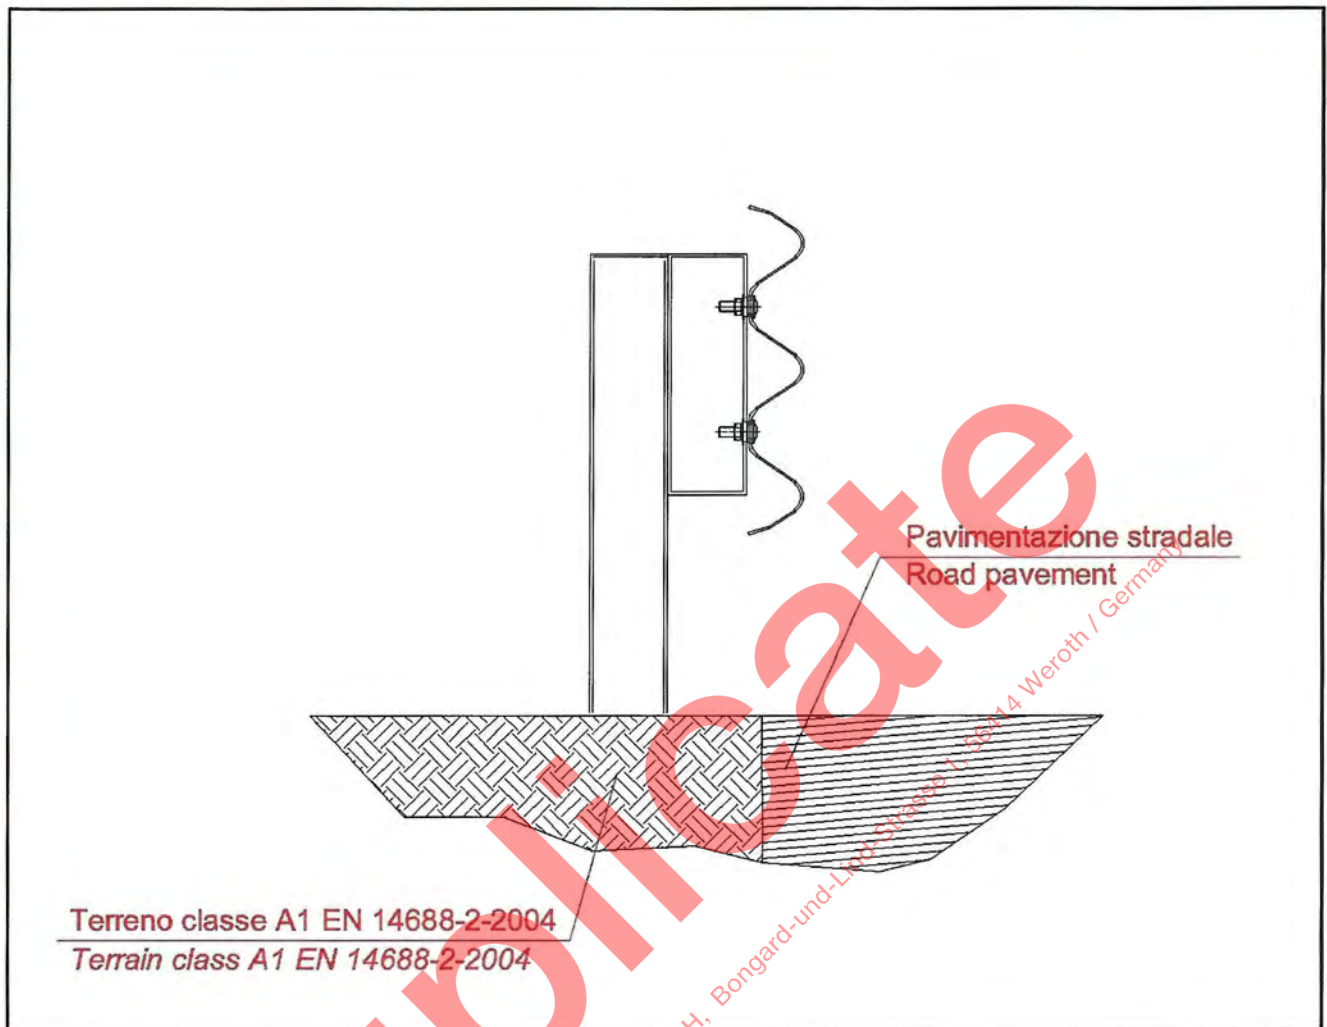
Figure 2 Sezione dell'installazione – The installation section
